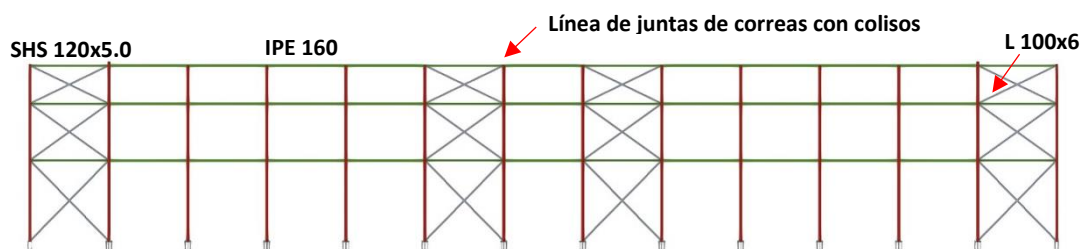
Pórtico de fachada lateral. Fuente: CYPE 3D.
